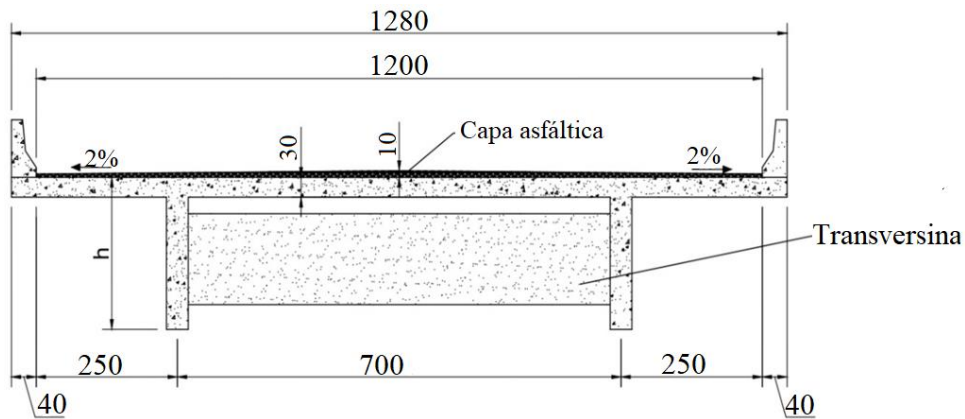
Sección transversal del puente (dimensiones en centímetros) (Autor propio, 2019).
